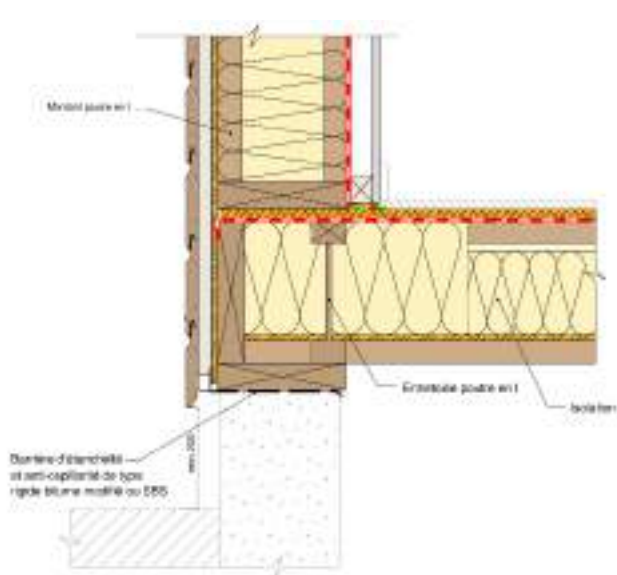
Liaison pied de mur extérieur / dalle bois avec poutres perpendiculaires au mur
